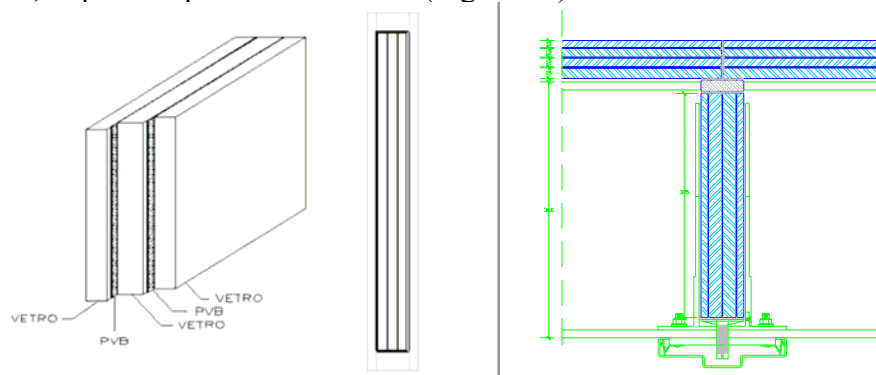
Vetro stratificato con PVB, vista frontale di una scarpa metallica di appoggio e sezione di trave composta con più lastre stratificate.
